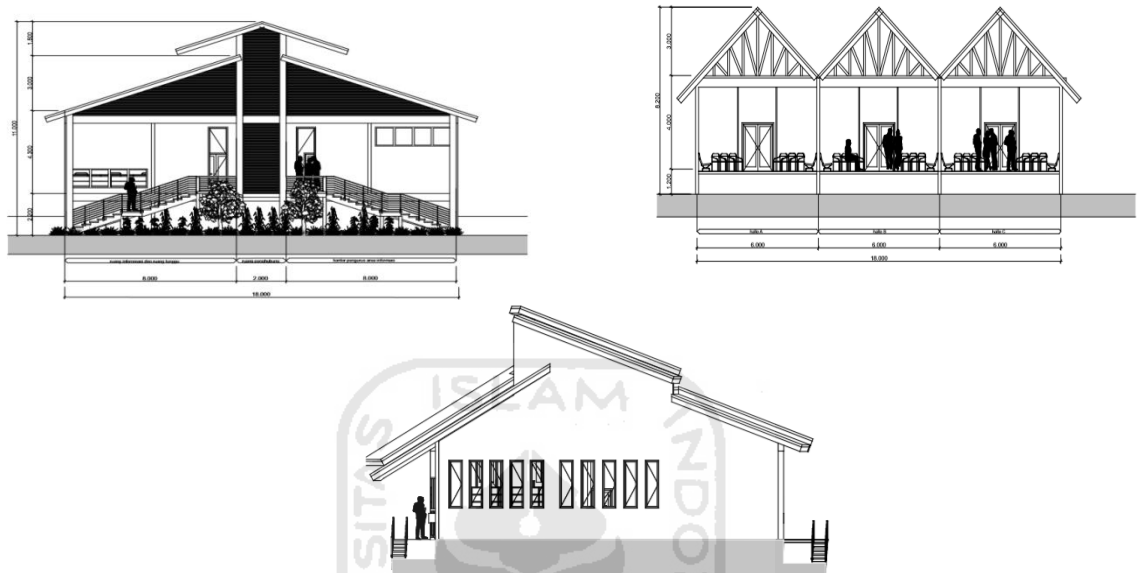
Denah bangunan penyewaan alat pertanian
